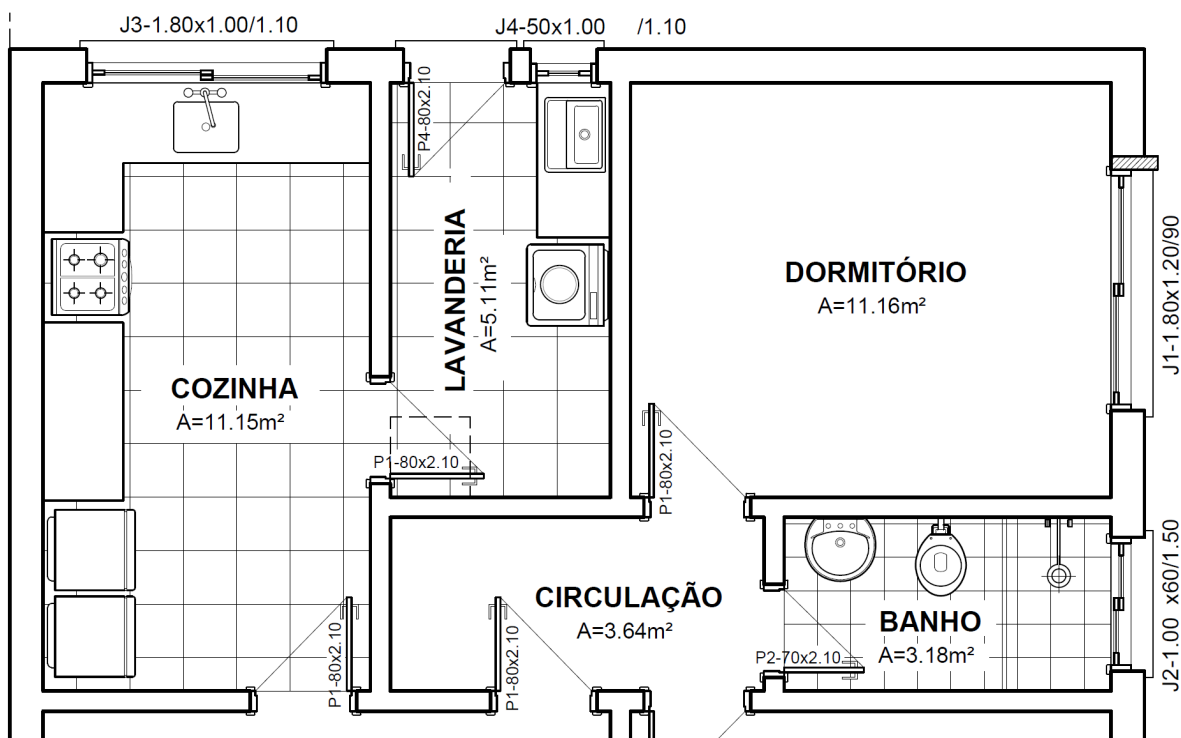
Etapas de representação da planta baixa: hachuras dos pisos. Fonte: autor
